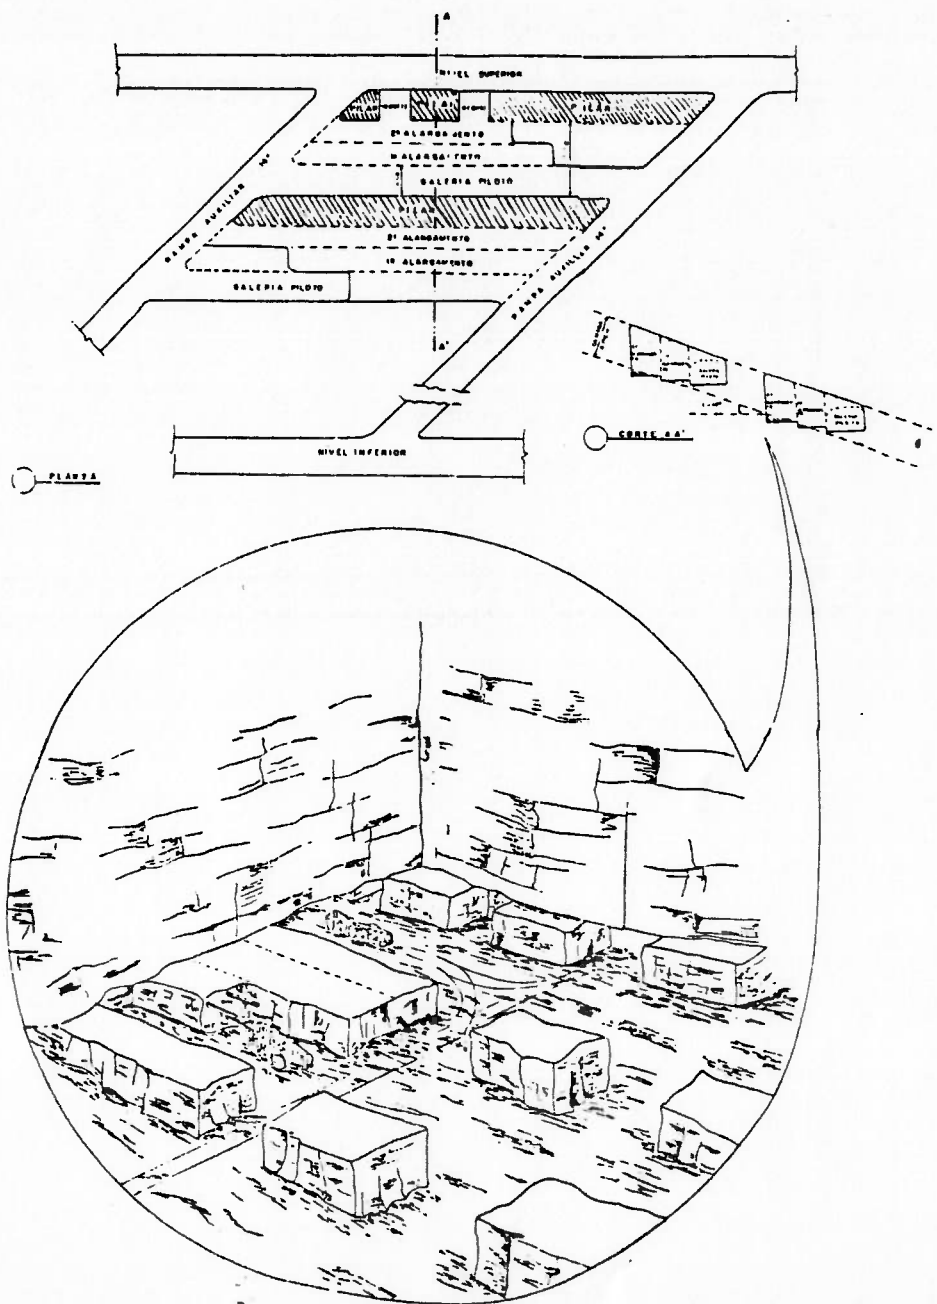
Em planta seqüência de alargamento das galerias horizontais de produção e do recorte dos pilares. Em corte a disposição das câmaras no filão. Em perspectiva a disposição final dos pilares.
